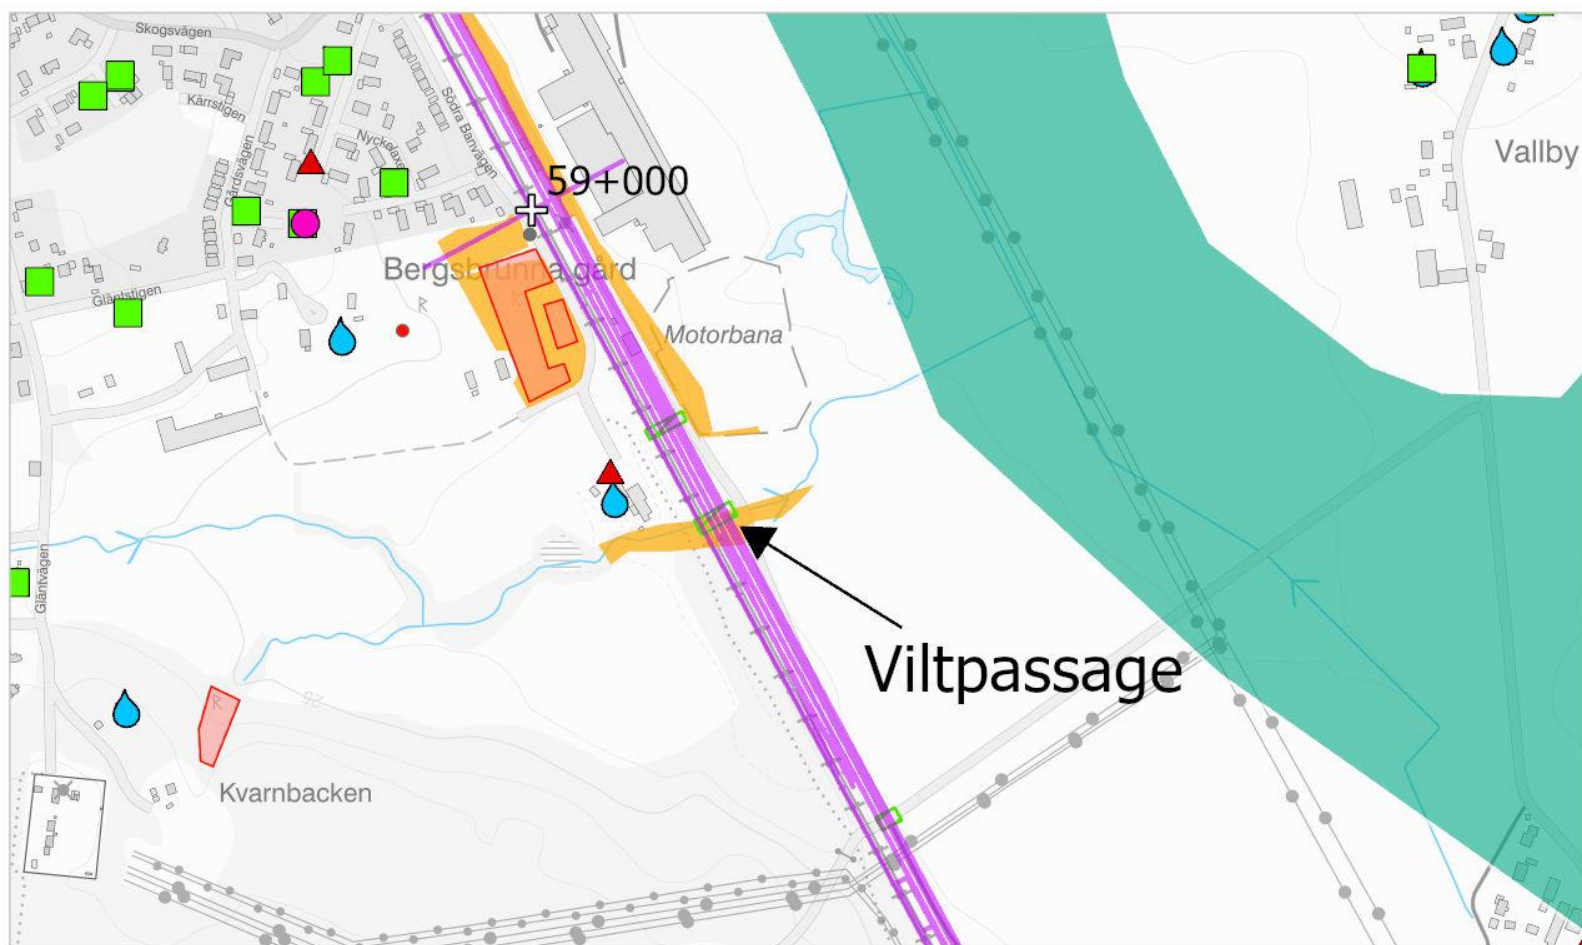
Planerad brokonstruktion vid viltpassagen i planvy.
